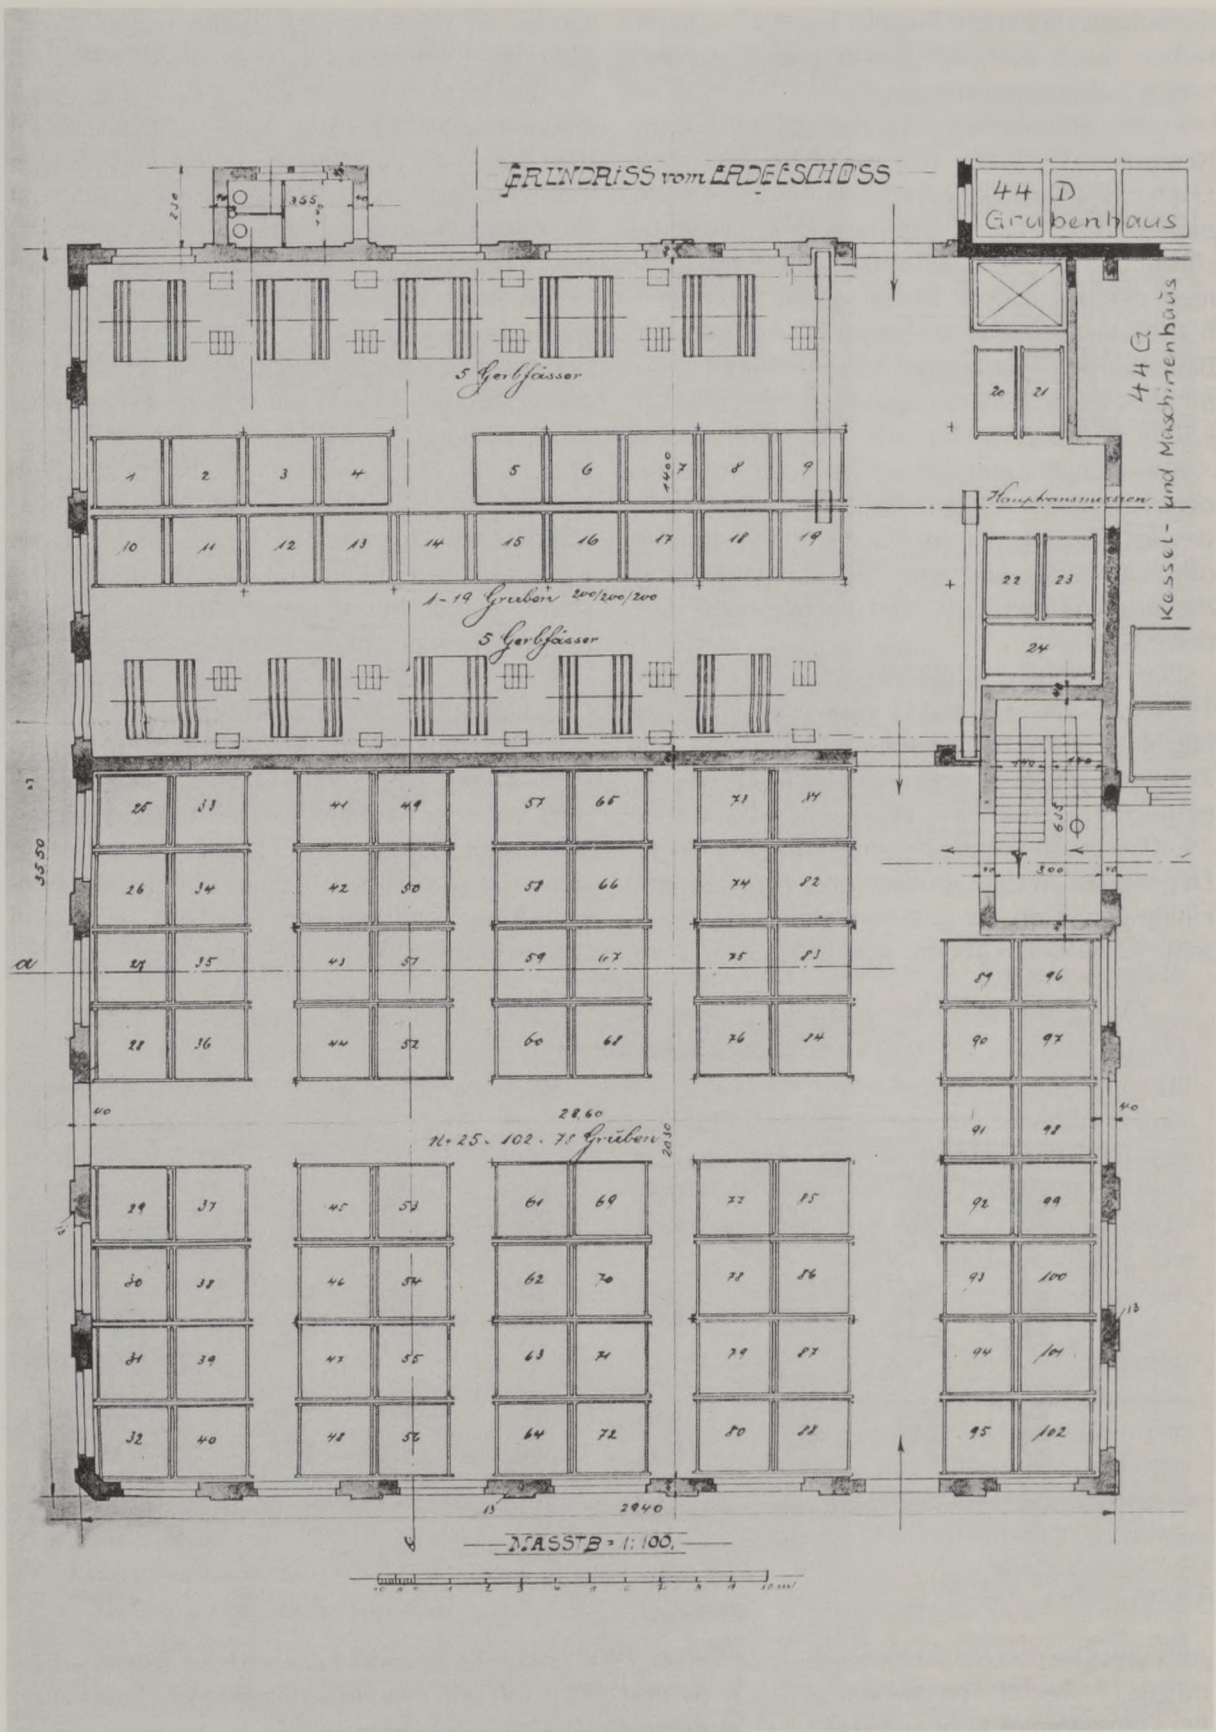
Grundriss vom Erdgeschoss des neuen Grubenhauses, Biegel 11, in dem auch 10 weitere Gerbfässer zur Aufstellung kamen (Baujahr 1908/09).
